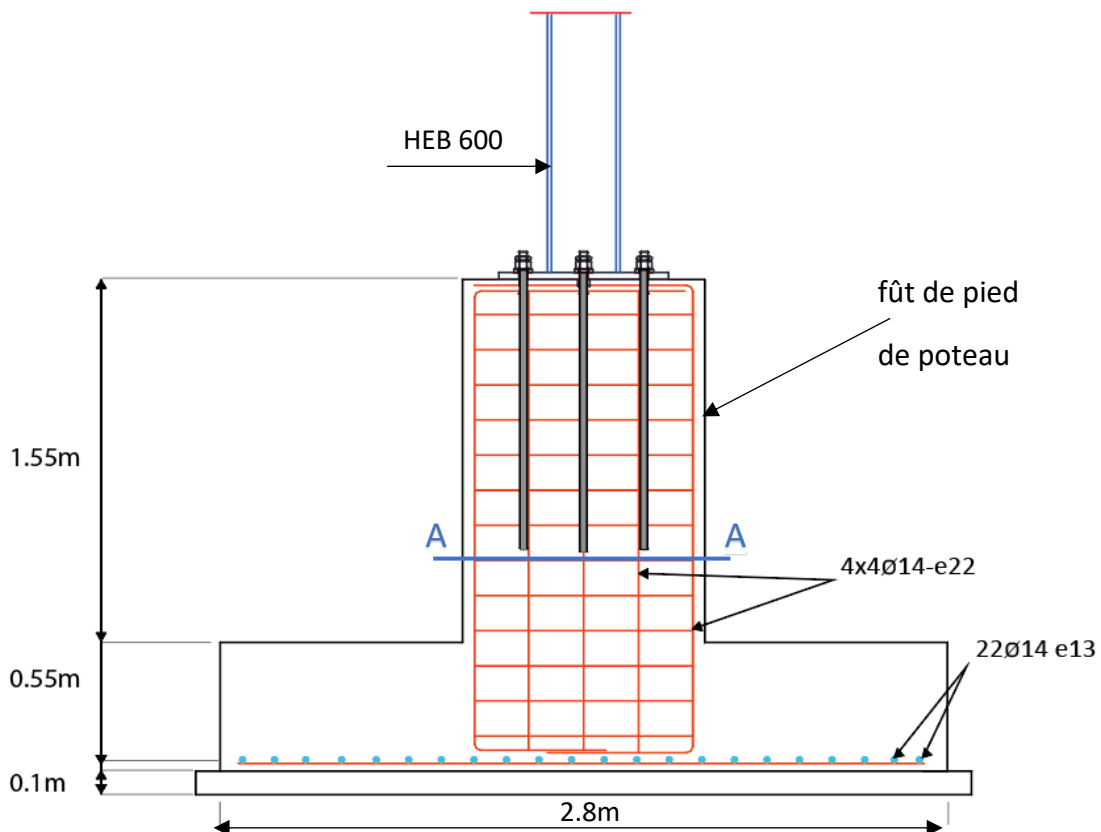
Schéma de ferrailage de la semelle isolée sous poteau
